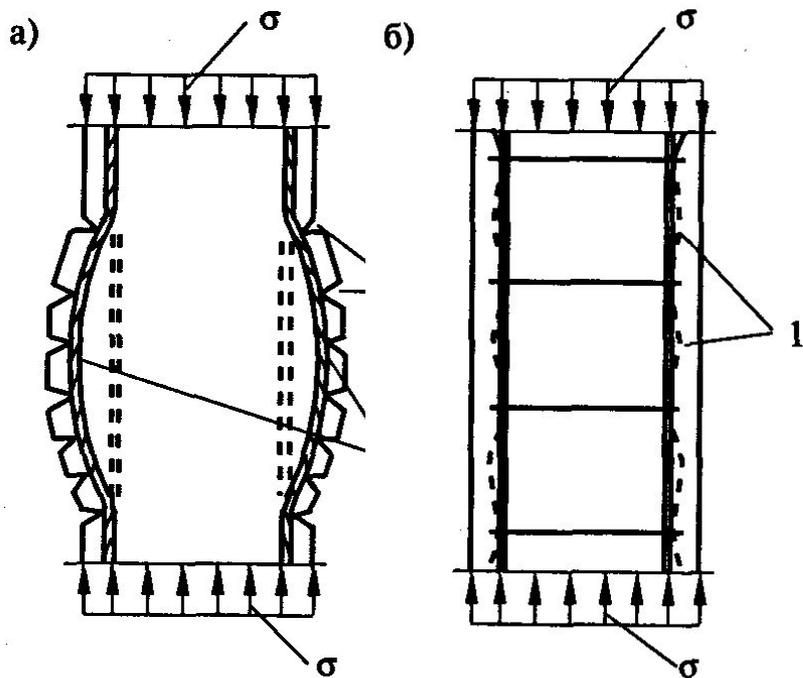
Потеря устойчивости арматуры в сжатом железобетонном элементе: а - при отсутствии поперечной арматуры; б - при наличии поперечной арматуры (хомутов); 1 – выпучивание продольной арматуры; 2 – разрушение бетона
